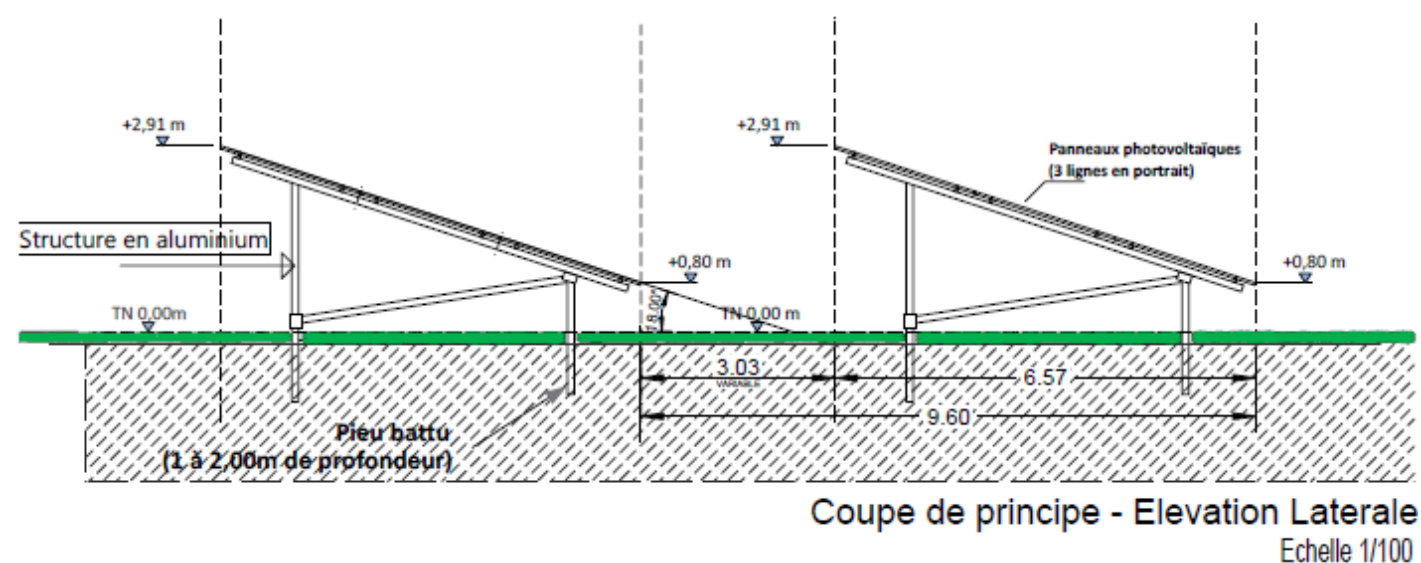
Coupe de principe des structures (Source : AD Agence)
